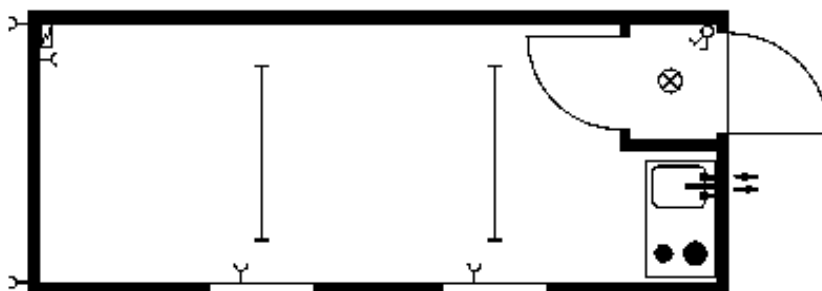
Půdorys skladového kontejneru CONTIMADE Standard typ 24 [50]
